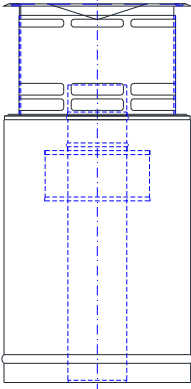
Réutilisation de conduit existant avec conduit flexible avec prise d'air comburant concentrique en toiture
